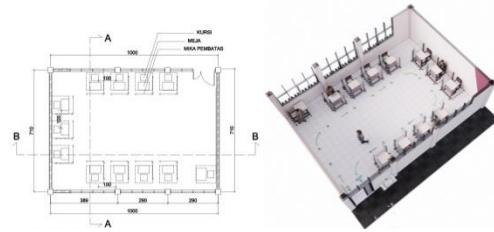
Denah Ruang studio 3-1 tipe Rectangle
